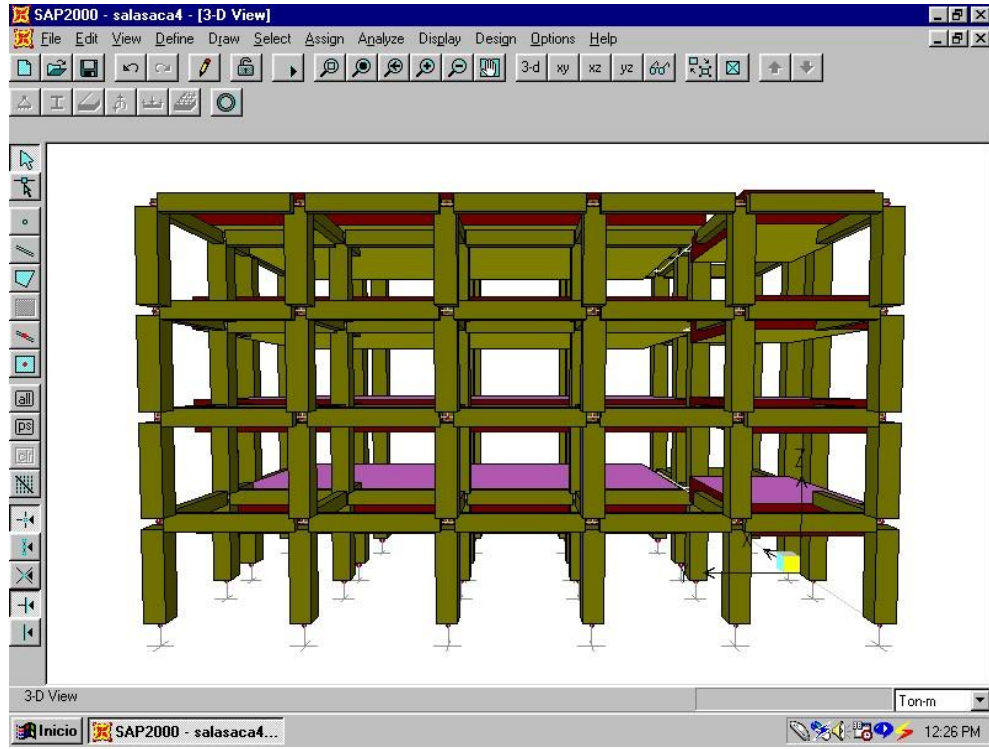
Pórtico espacial. Secciones de vigas, columnas y losas en el plano X-Z.
